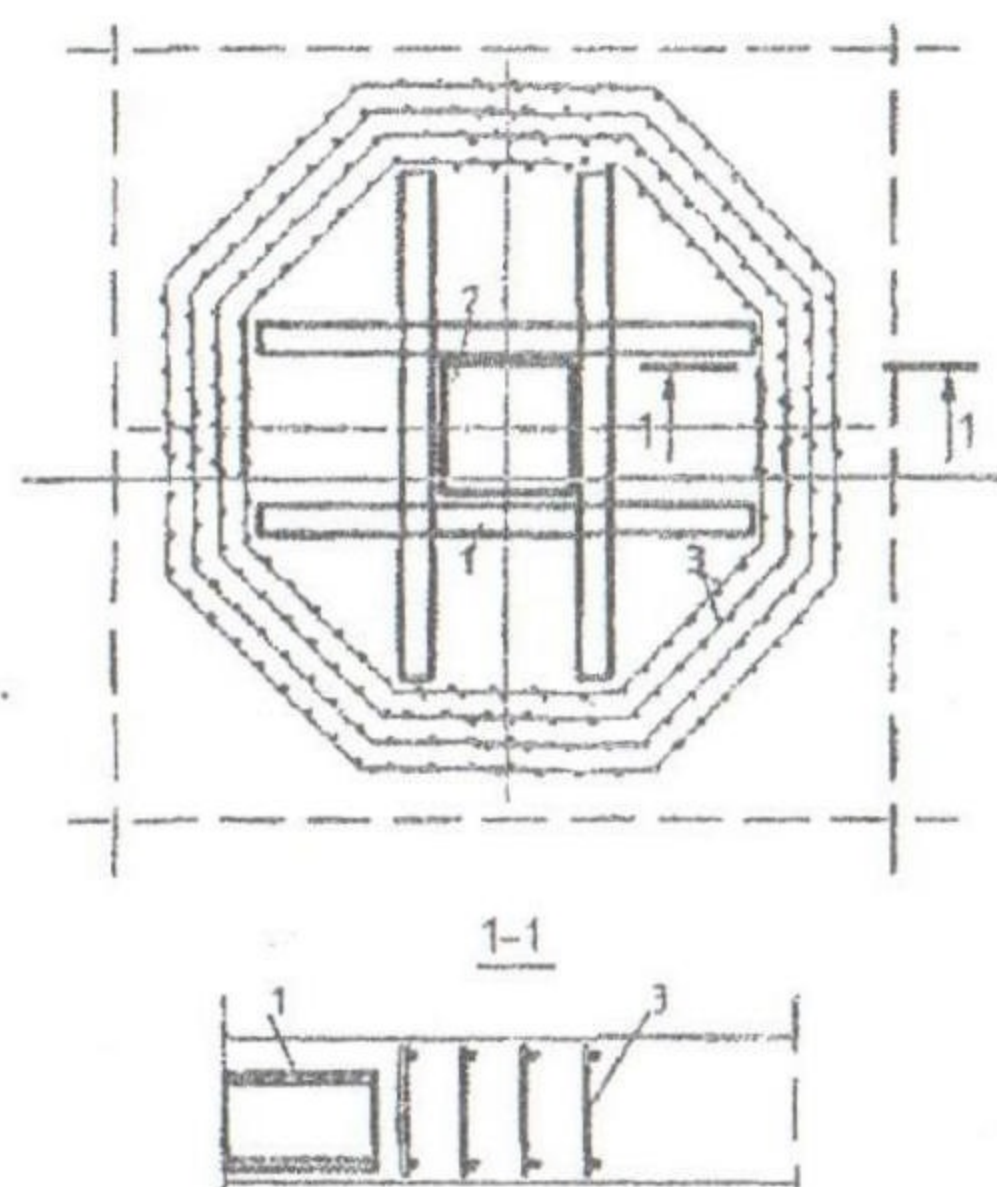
Стыковое соединение безреберной плиты с жесткой арматурой и стержневыми хомутами: 1 - жесткая арматура; 2 - колонна; 3- поперечная арматура
